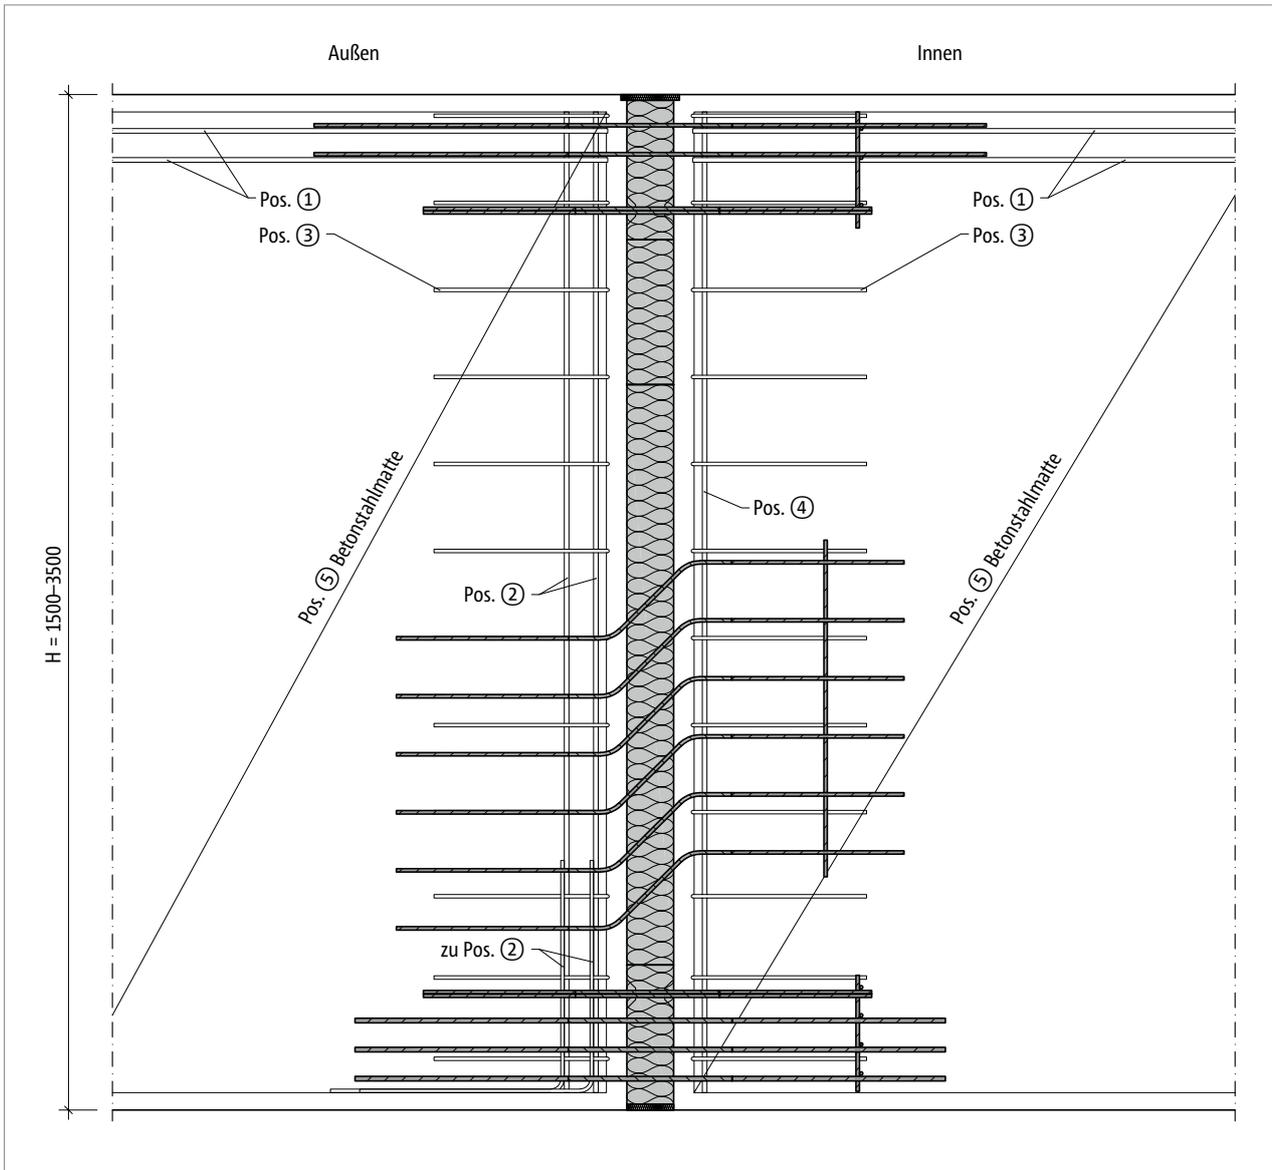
Schöck Isokorb® T Typ W: Bauseitige Bewehrung; Schnitt
